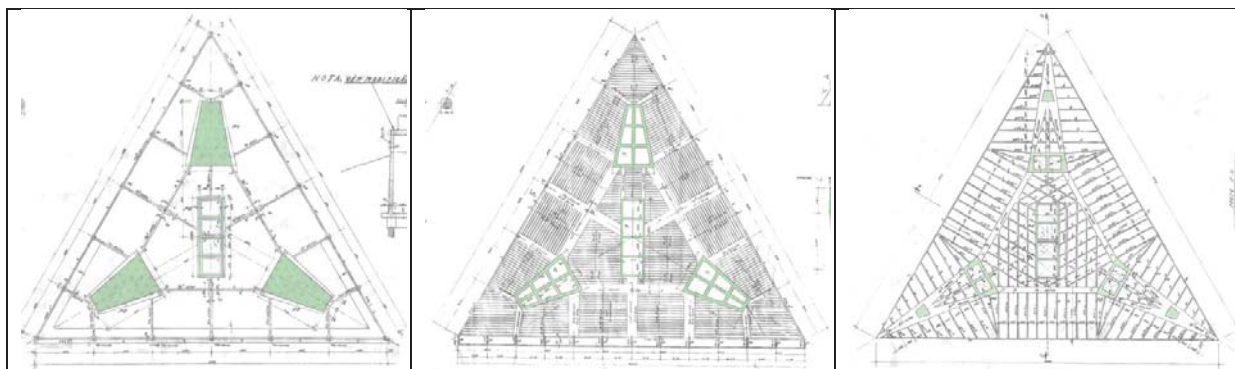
Plantas de forma do subsolo, térreo e superior (fonte ArPDF)
